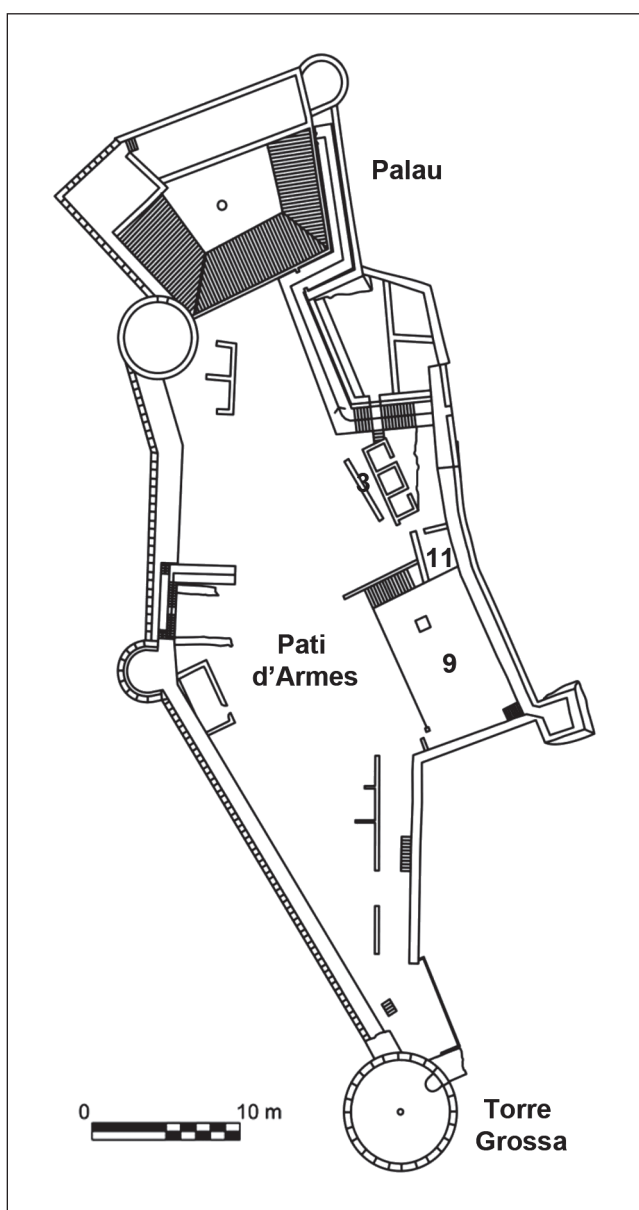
Planta del Castell de Castalla y ubicación de tres de las estructuras sobre las cuales se intervino.
